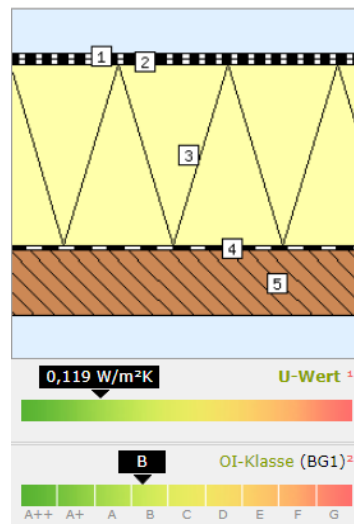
Alternativer Bauteilaufbau, Flachdach aus Holz
